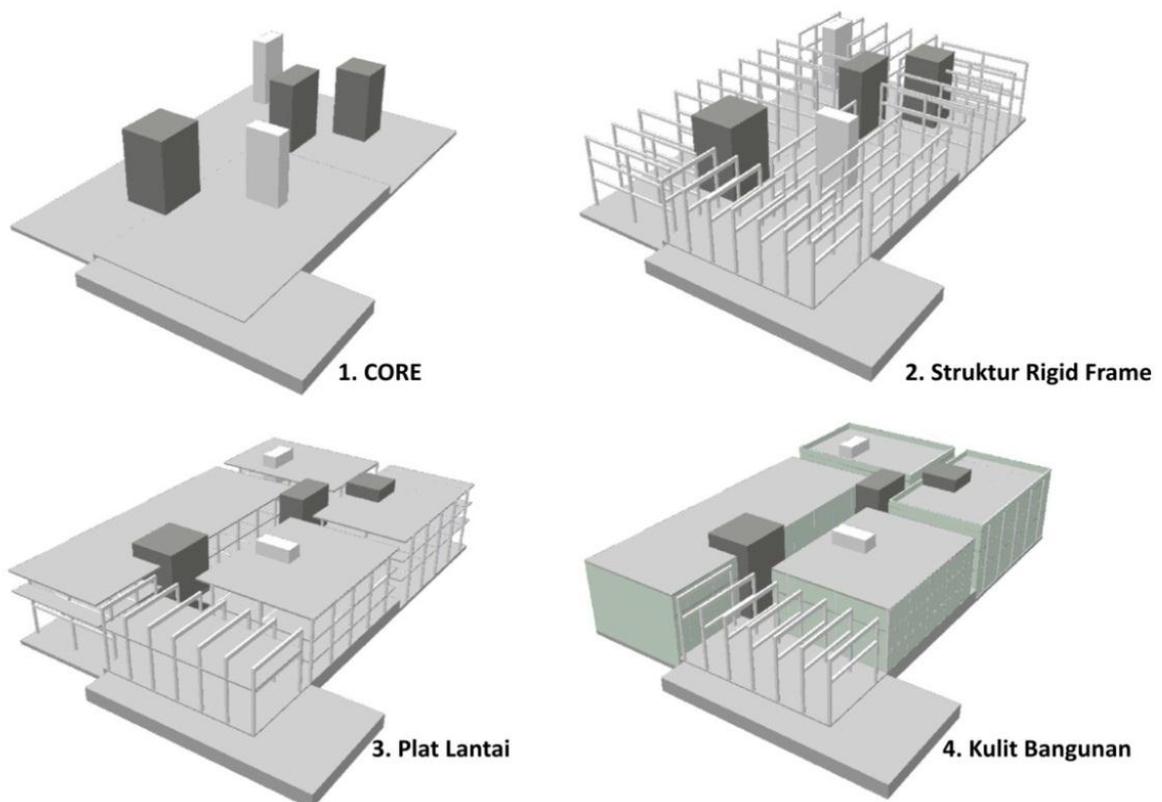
Detail Tahapan Rencana Struktur
